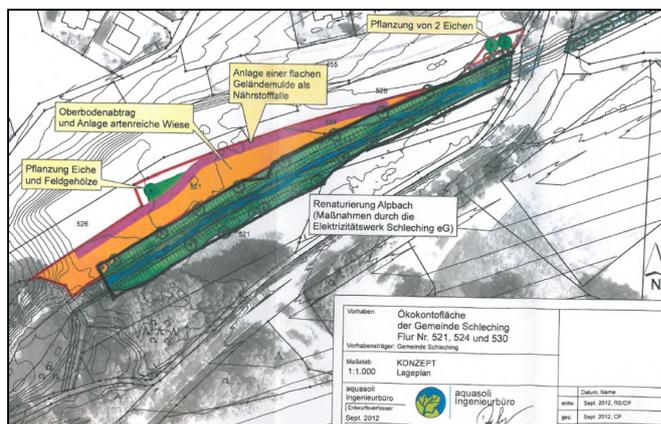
Praxisbeispiel Gemeinde Schleching; Lageplan der Bachaufweitung auf Ausgleichsflächen des E-Werkes. Quelle: Gemeinde Schleching
